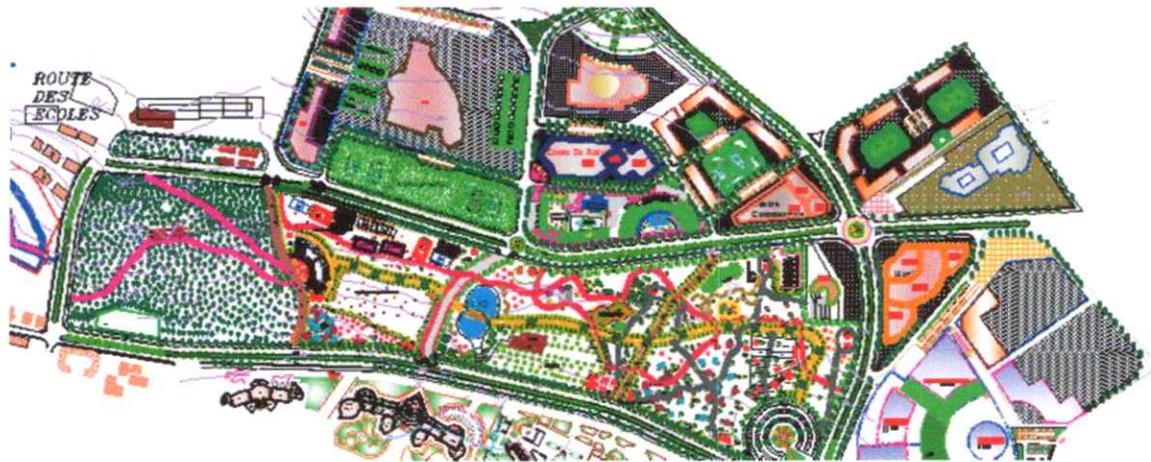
plan d'aménagement (Source : duc de tipaza pour la composition de au3 2009).voir annexe 5
